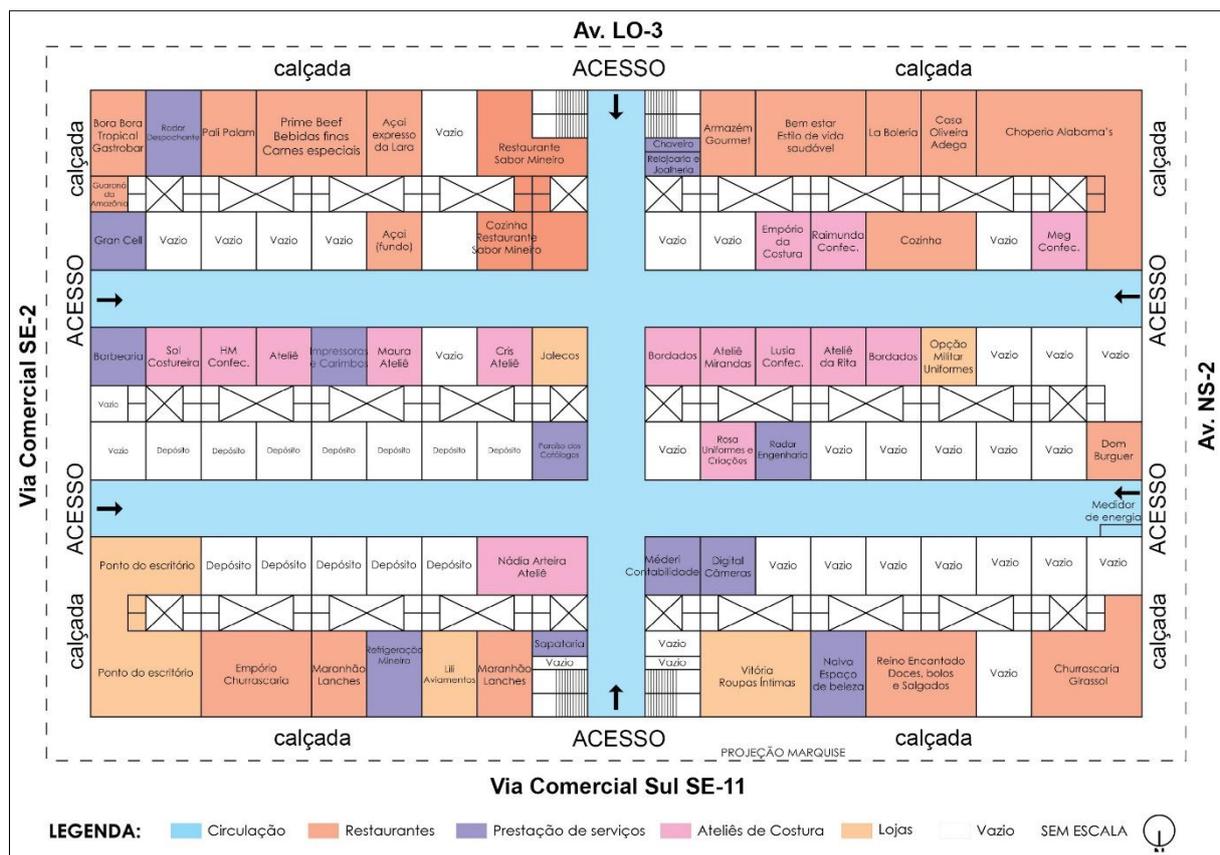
Galeria Wilson Vaz - Planta baixa pavimento térreo com usos atuais.
